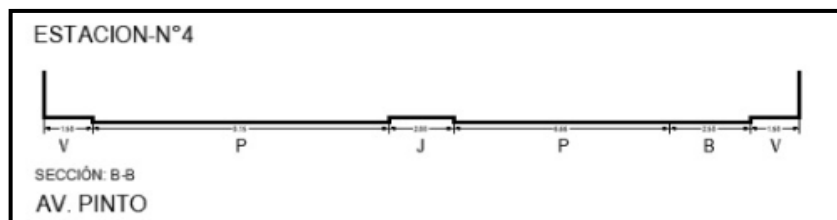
Corte B-B Sección Vial de la Av. Gustavo Pinto
